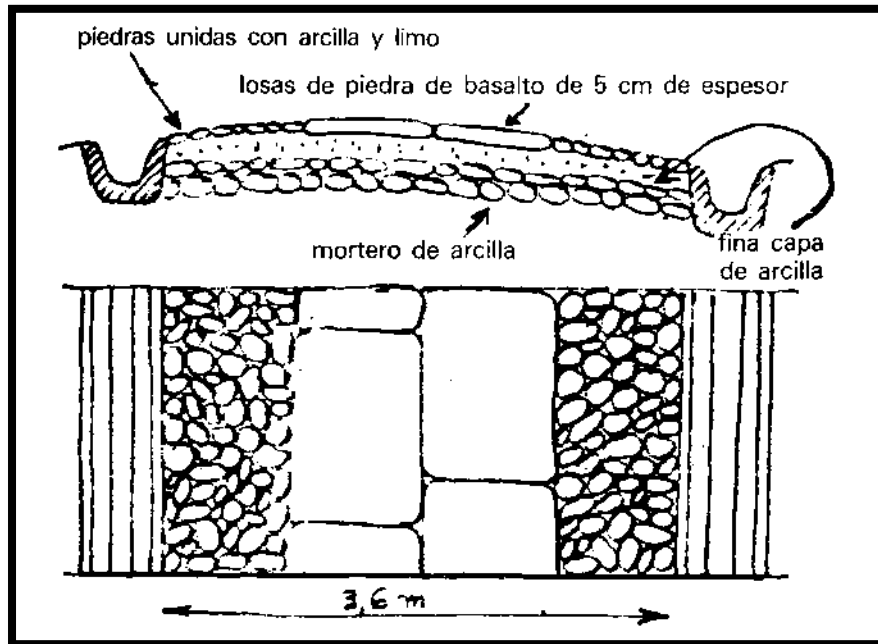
Características del pavimento usado en la Isla de Creta, (fuente: Gómez, 1970).
